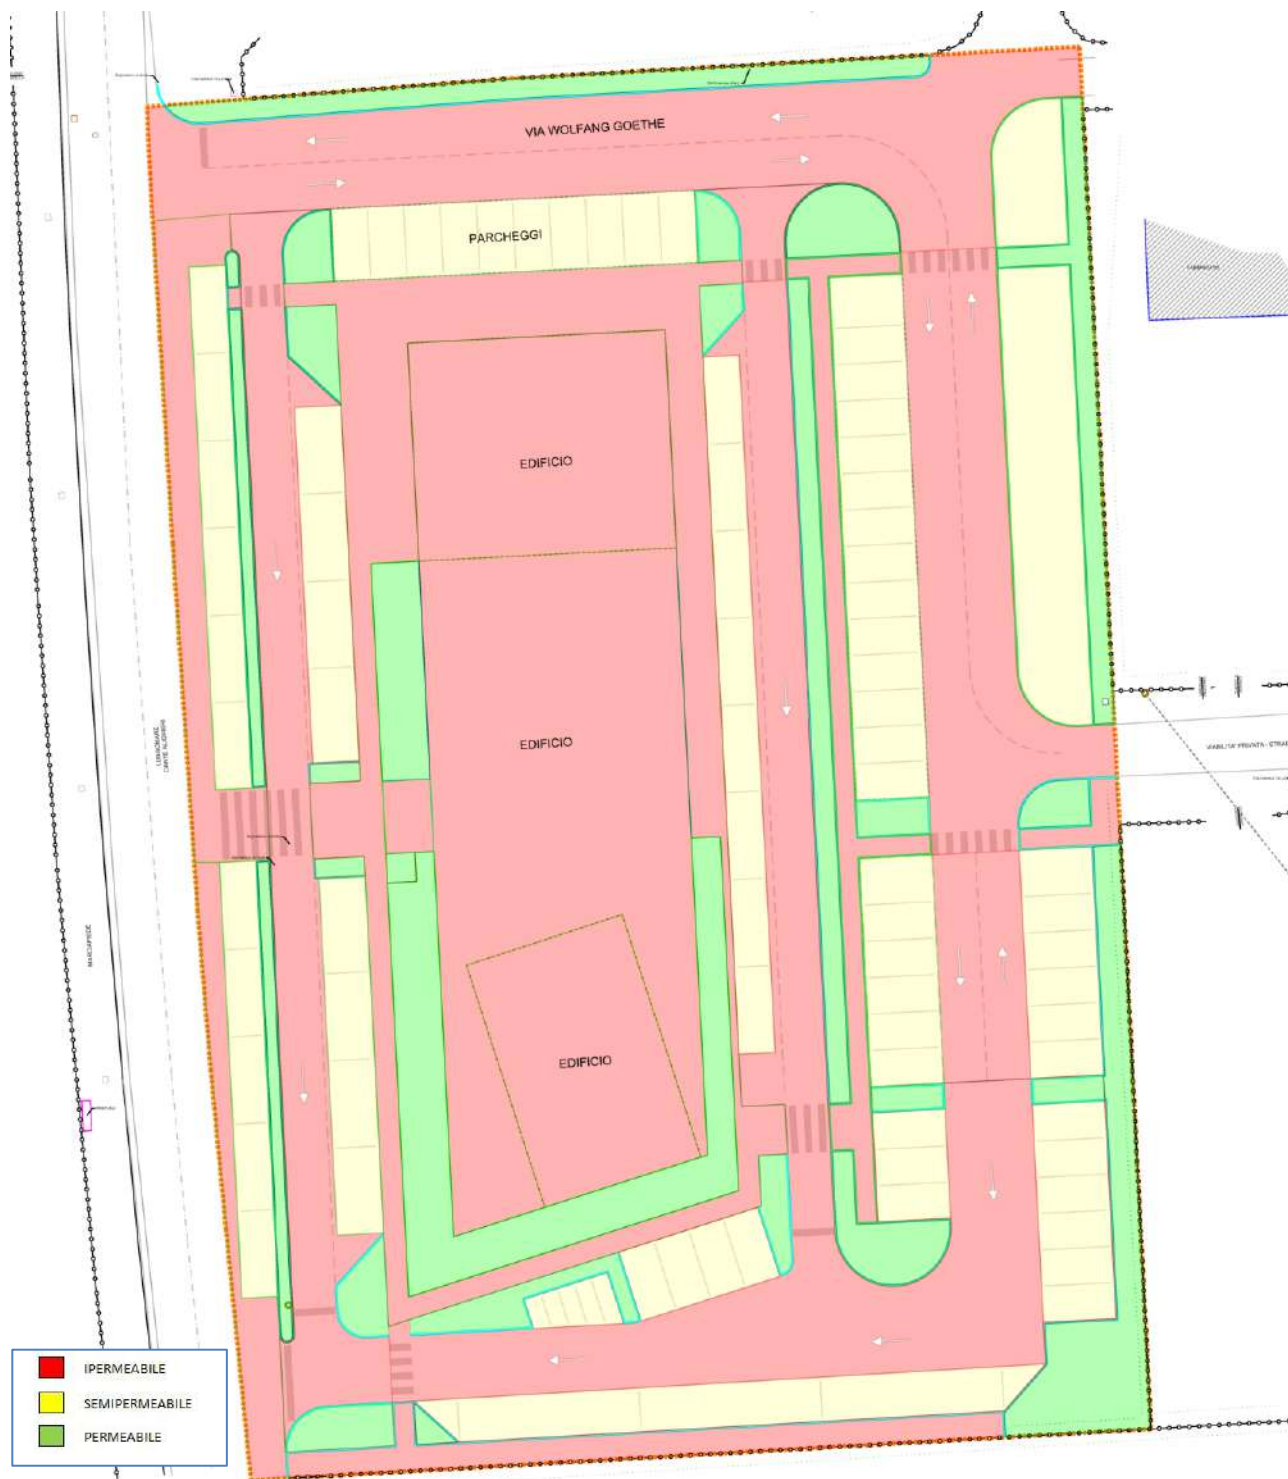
Caratteristiche di permeabilità delle aree in fase di progetto
